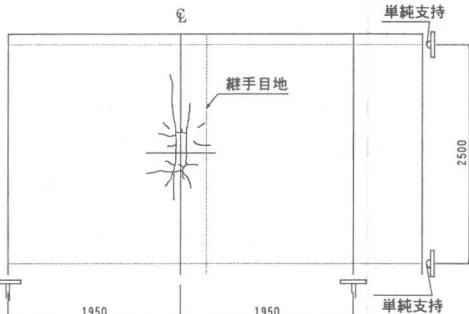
定点疲労試験終了時に観察された床版下面におけるコンクリートのひび割れ状況
